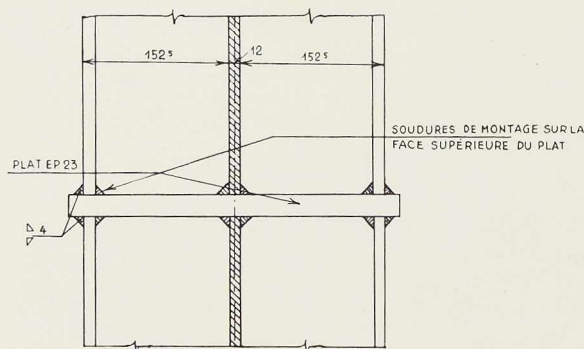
Ancien type de joint dans les montants, soudé sur place.
